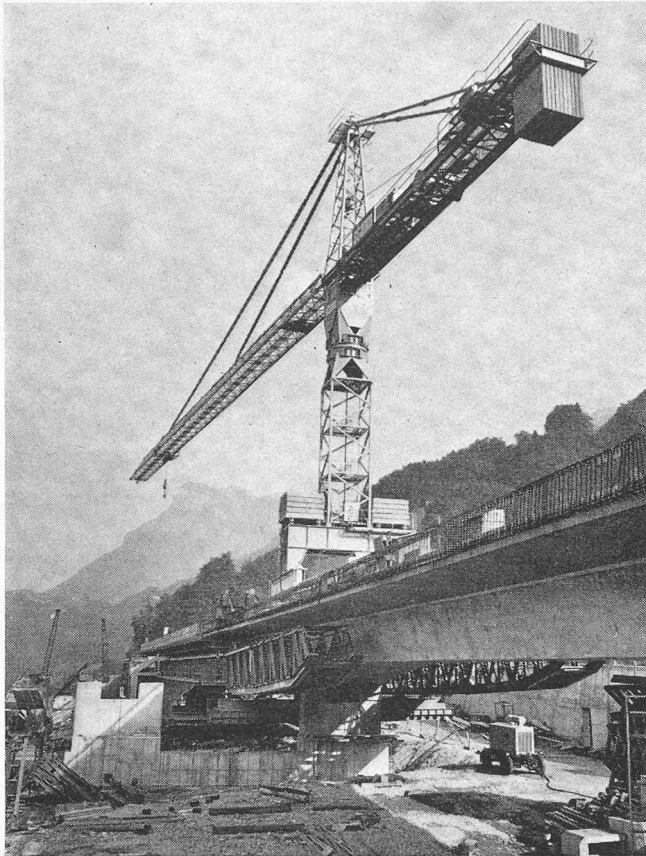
Laufkatzkran mit 67 m Ausladung zur Erstellung der bergseitigen Brücke. Der rund 140 t schwere Kran steht in der Arbeitsstellung über der Stütze und kann das 66 m weit entfernte Kragarmende der nächsten Überbaustappe bedienen. Im Vordergrund ist das erstellte Feld 2 zu sehen, das wegen der darunter verlaufenden Anschlussstrasse mit reduzierter Konstruktionshöhe voutenförmig ausgebildet ist. Unter der Brücke sind die zwei kurzen aufgehenden Pfeiler zu sehen, die auf dem Stützenquerträger 3 stehen (Aufnahme: A. Odermatt, 10. 9. 1977)
